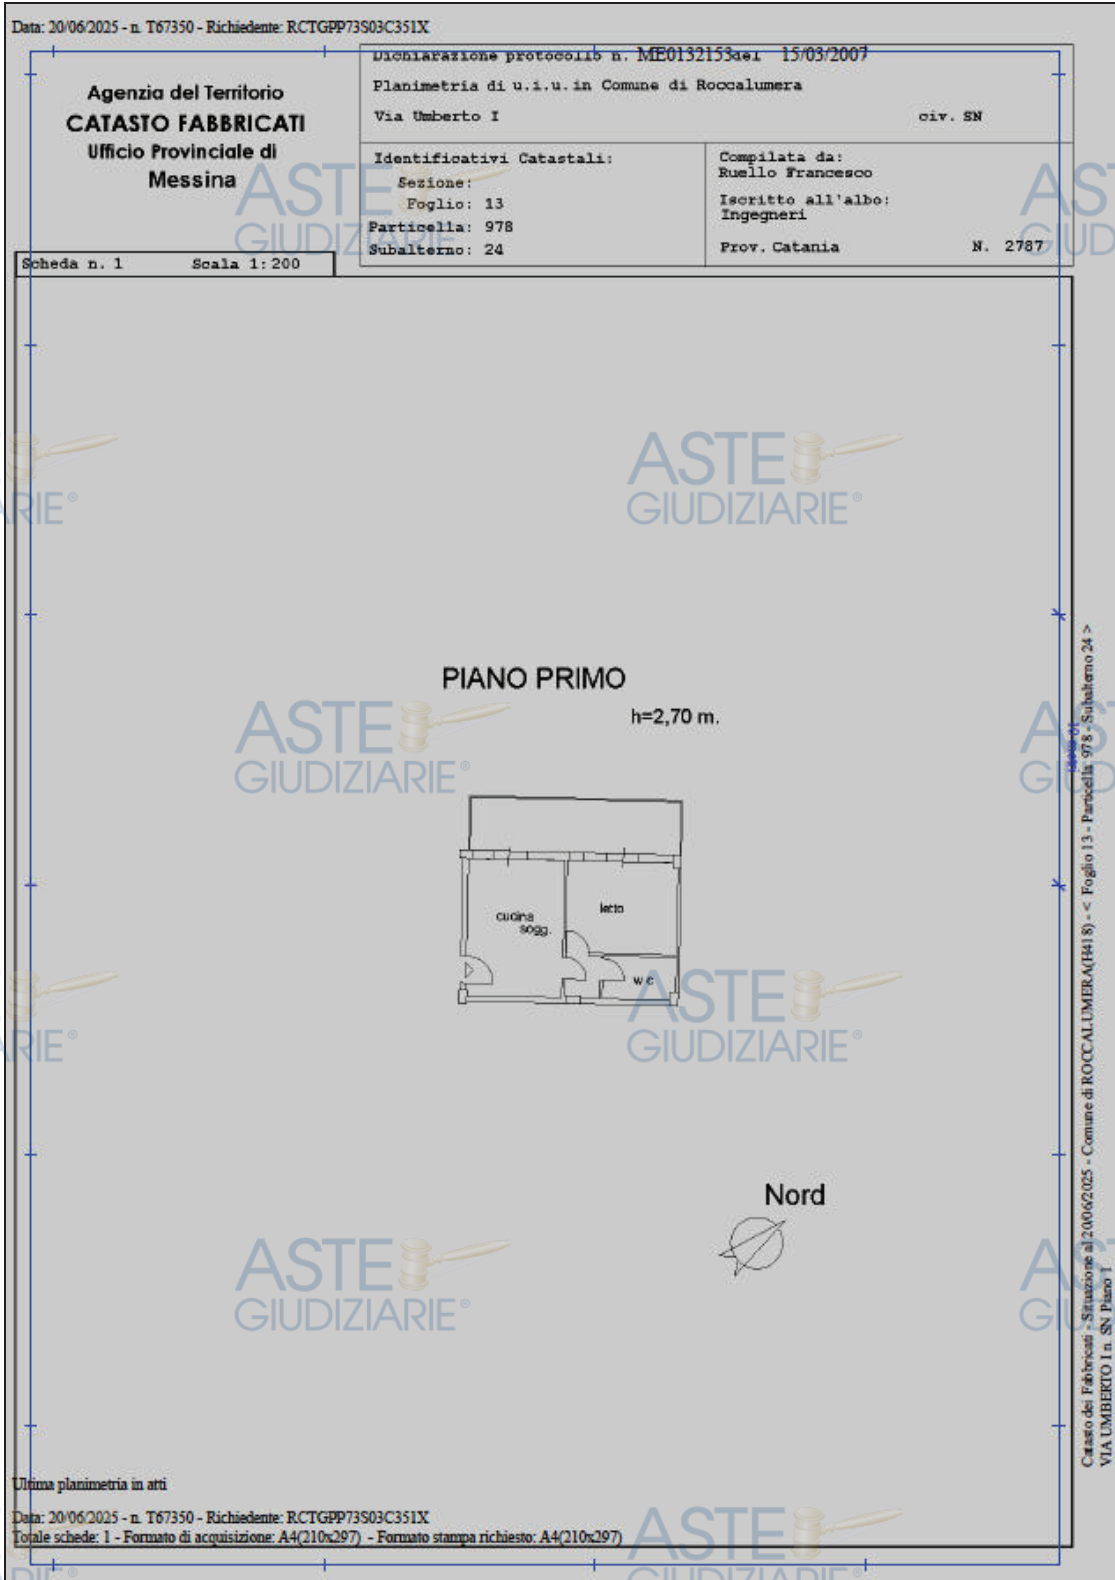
Visualizzazione della planimetria catastale dell'immobile destinato ad appartamento
